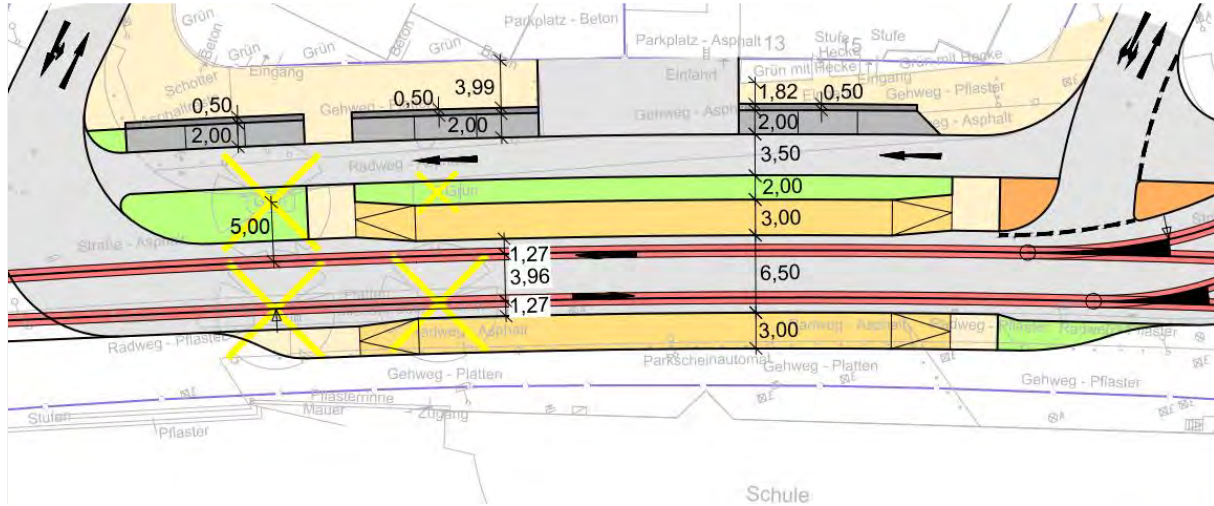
Variante 1 – Straßengebundener Bahnkörper
